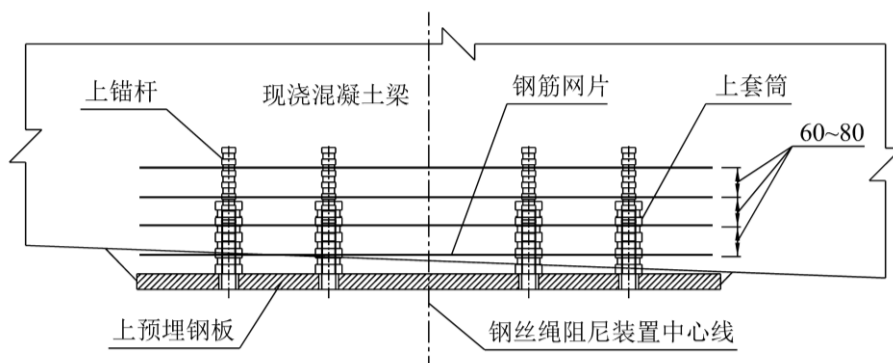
现浇混凝土梁钢丝绳阻尼装置锚固区域钢筋网片布置立面
